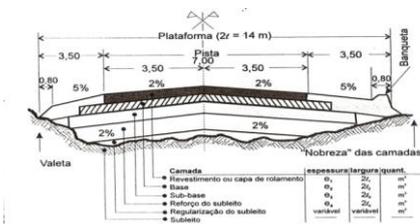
Seção Transversal Típica de um Pavimento Flexível:
